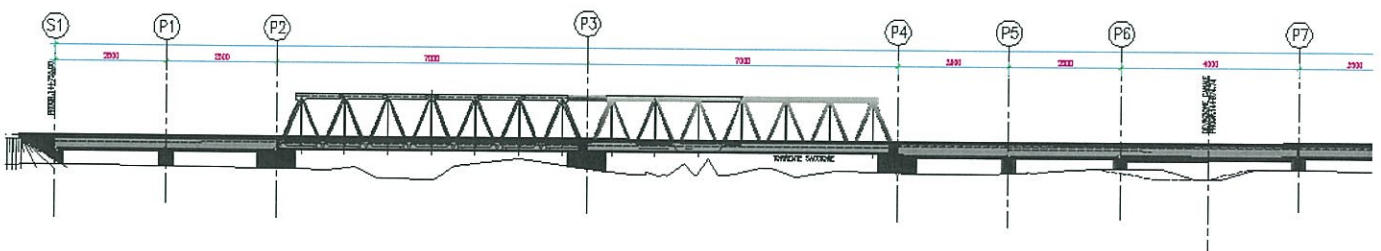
Viadotto sul torrente Saccione: stralcio del prospetto
